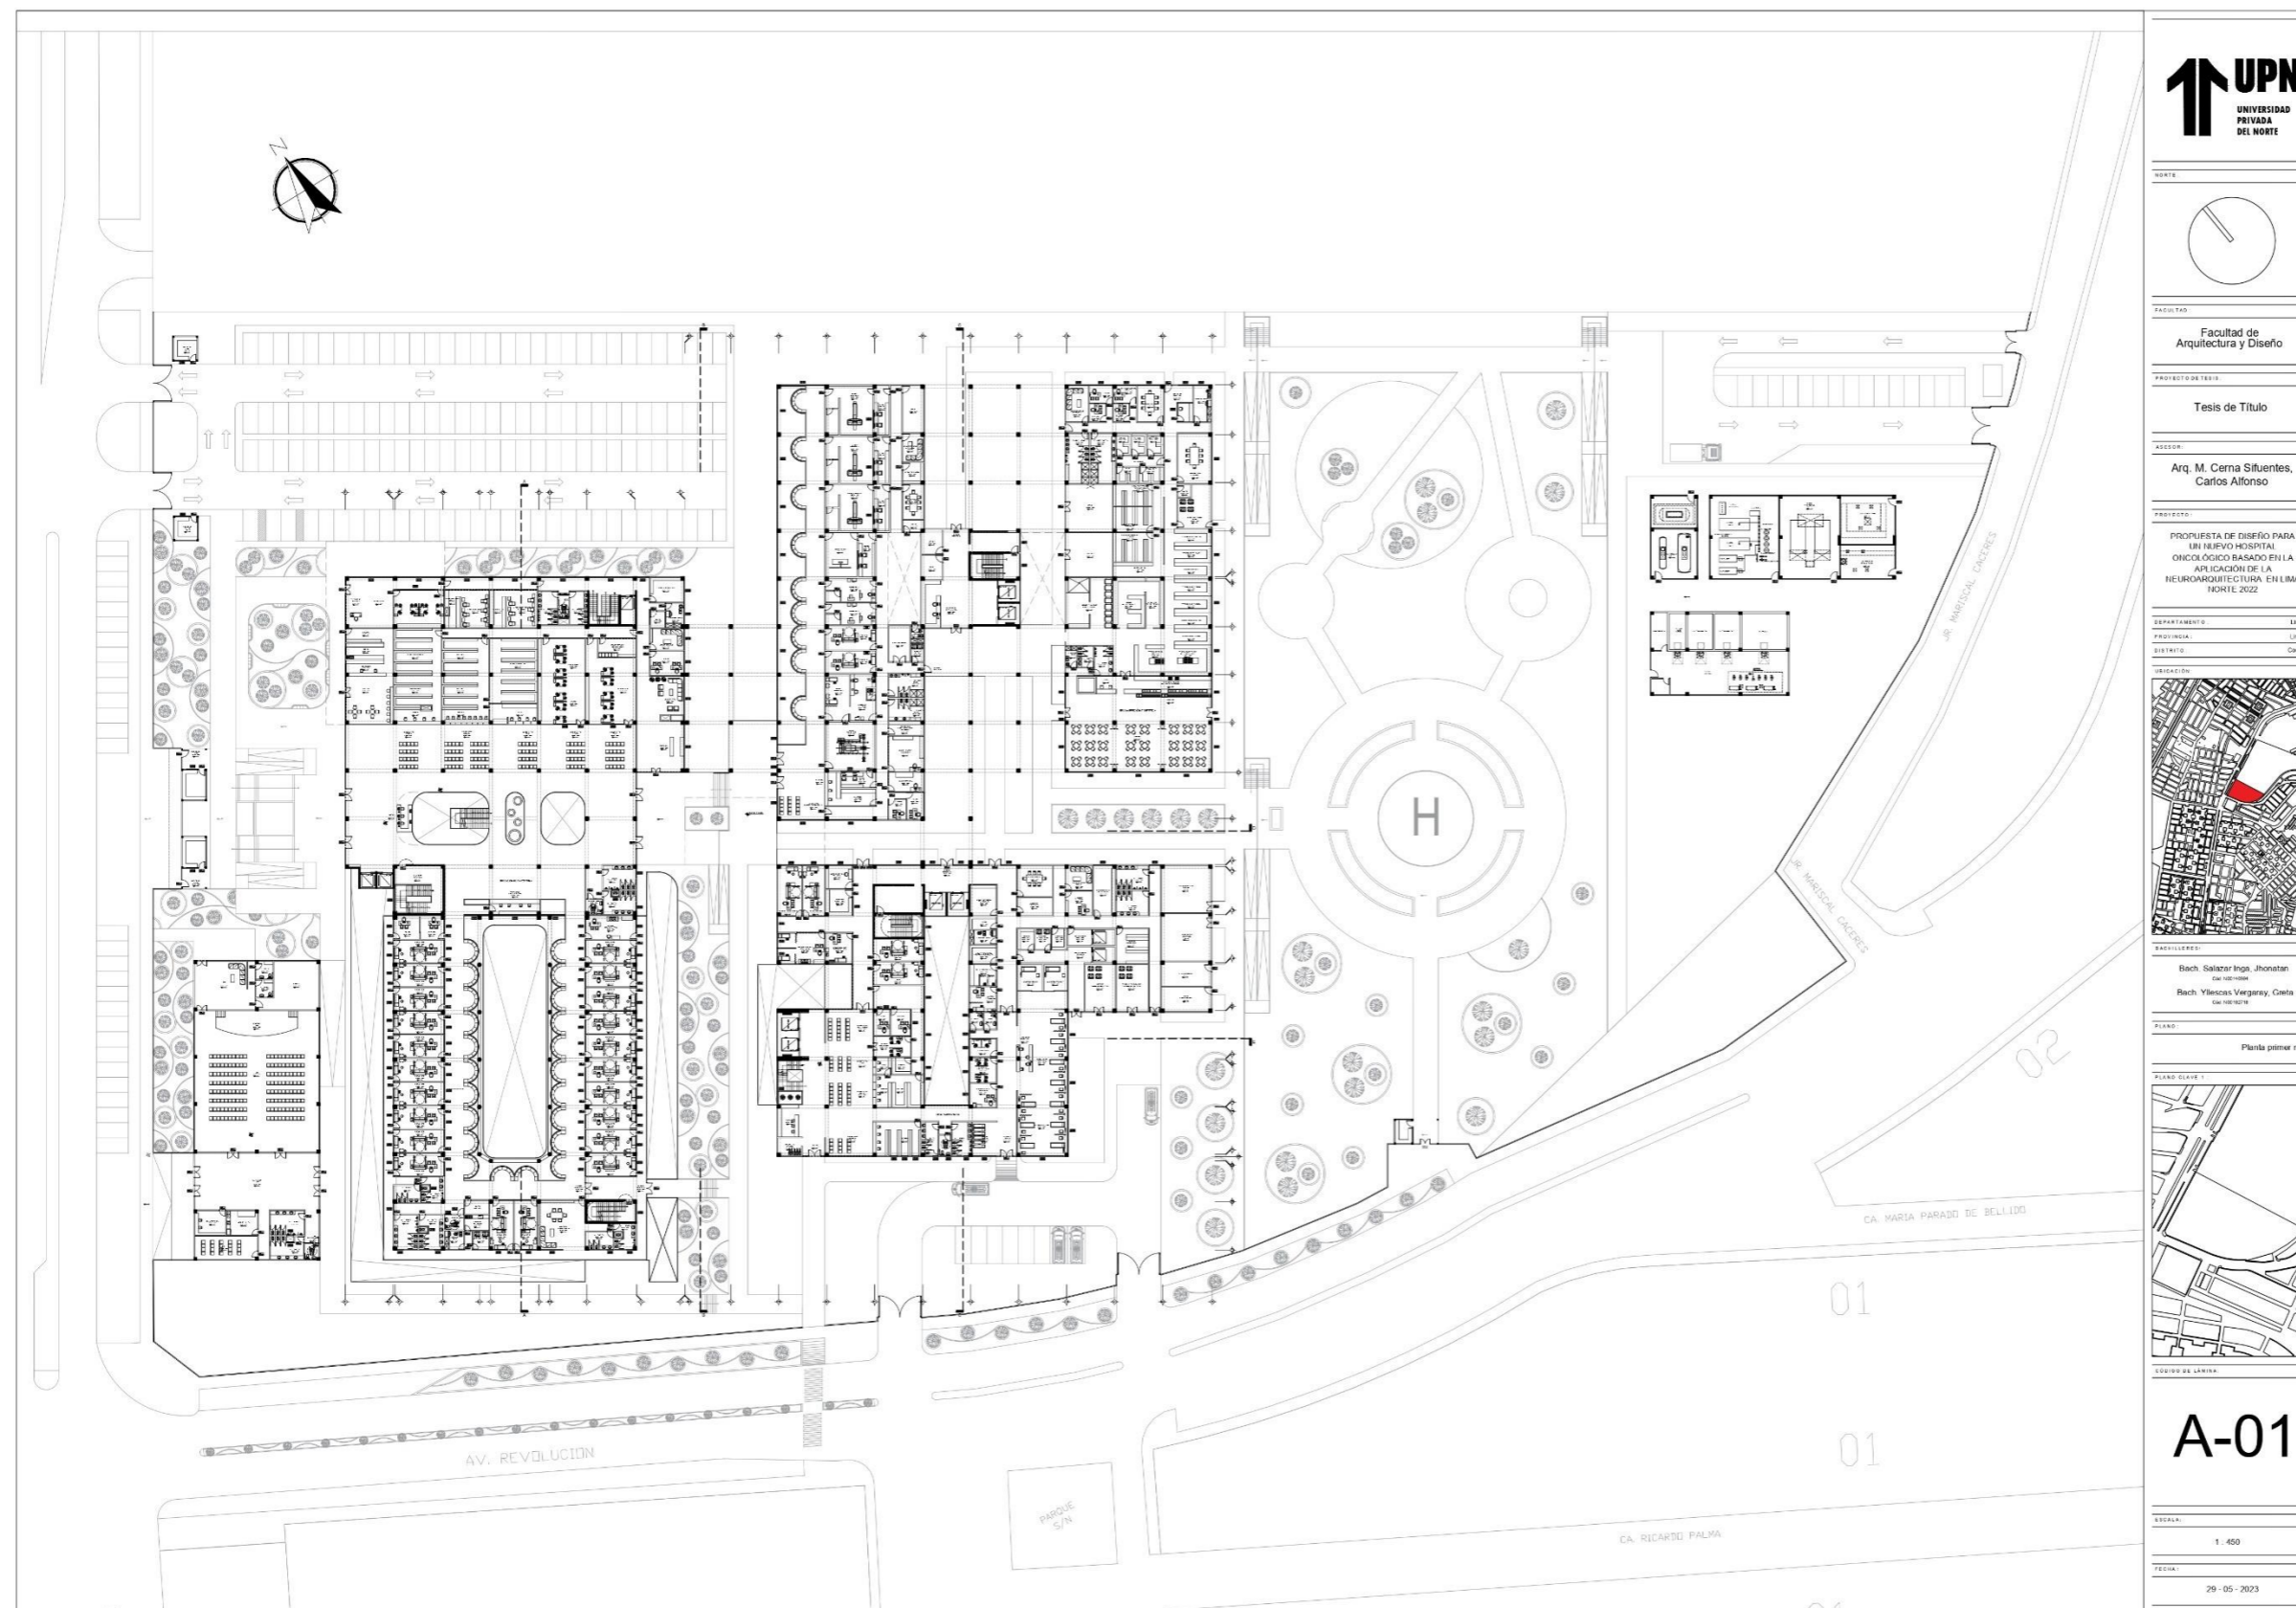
Arquitectura – Plot plan (Fuente: Elaboración propia de los coautores)
